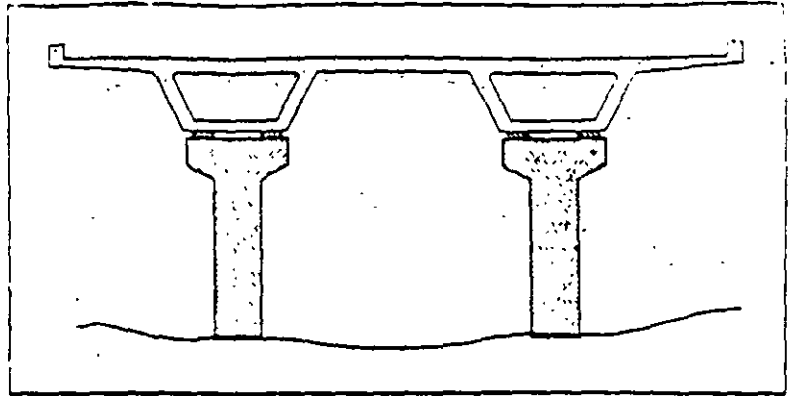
Pila, tipo 31,, 2 o más columnas con cabezales separadas
